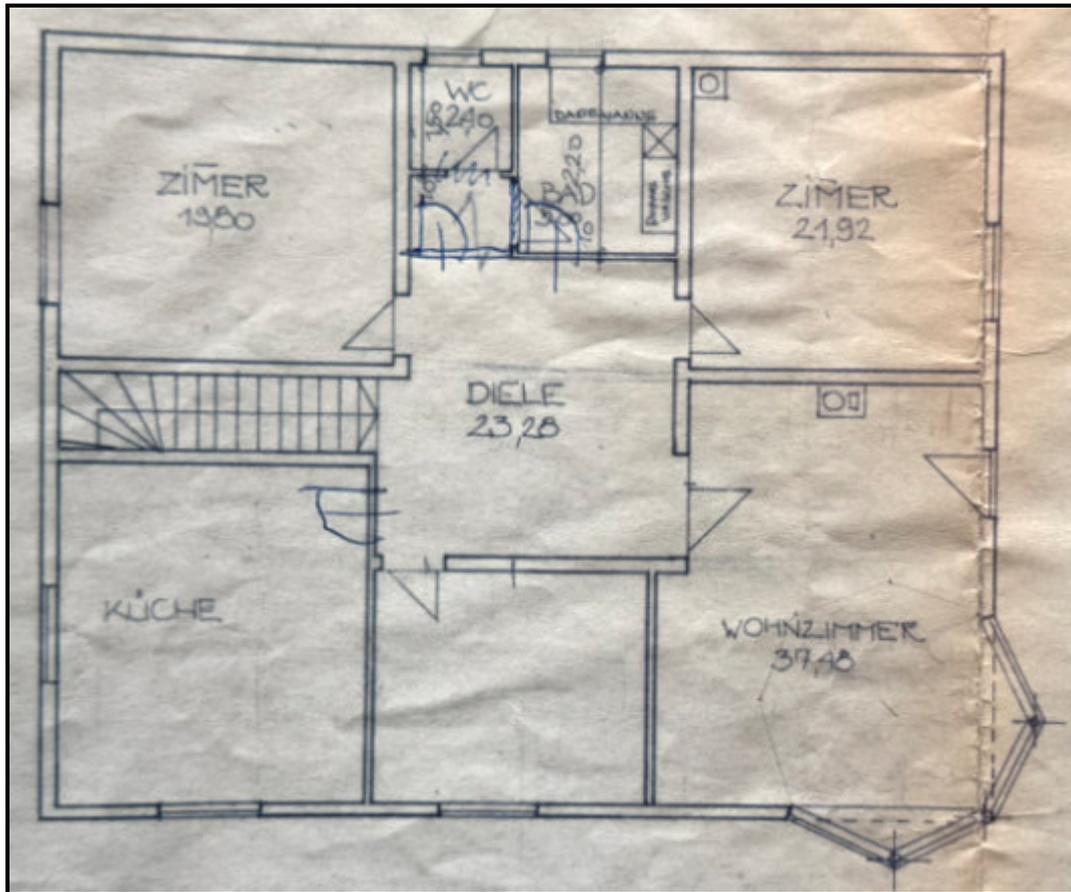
Grundrissplan Erdgeschoß
